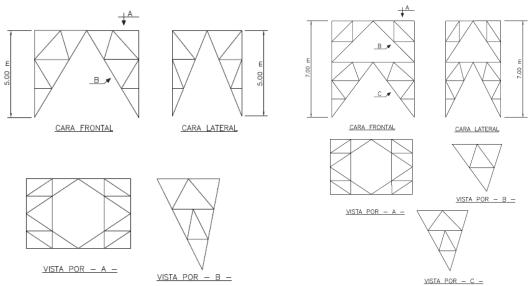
Detalles constructivos del recrecido de los apoyos (recrecido de 5 y 7 m). Fuente: Red Eléctrica
